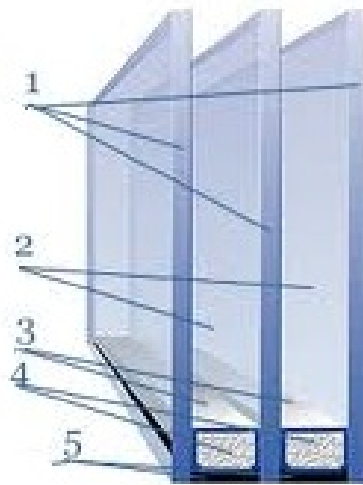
Конструктивна схема двокамерного склопакету:
